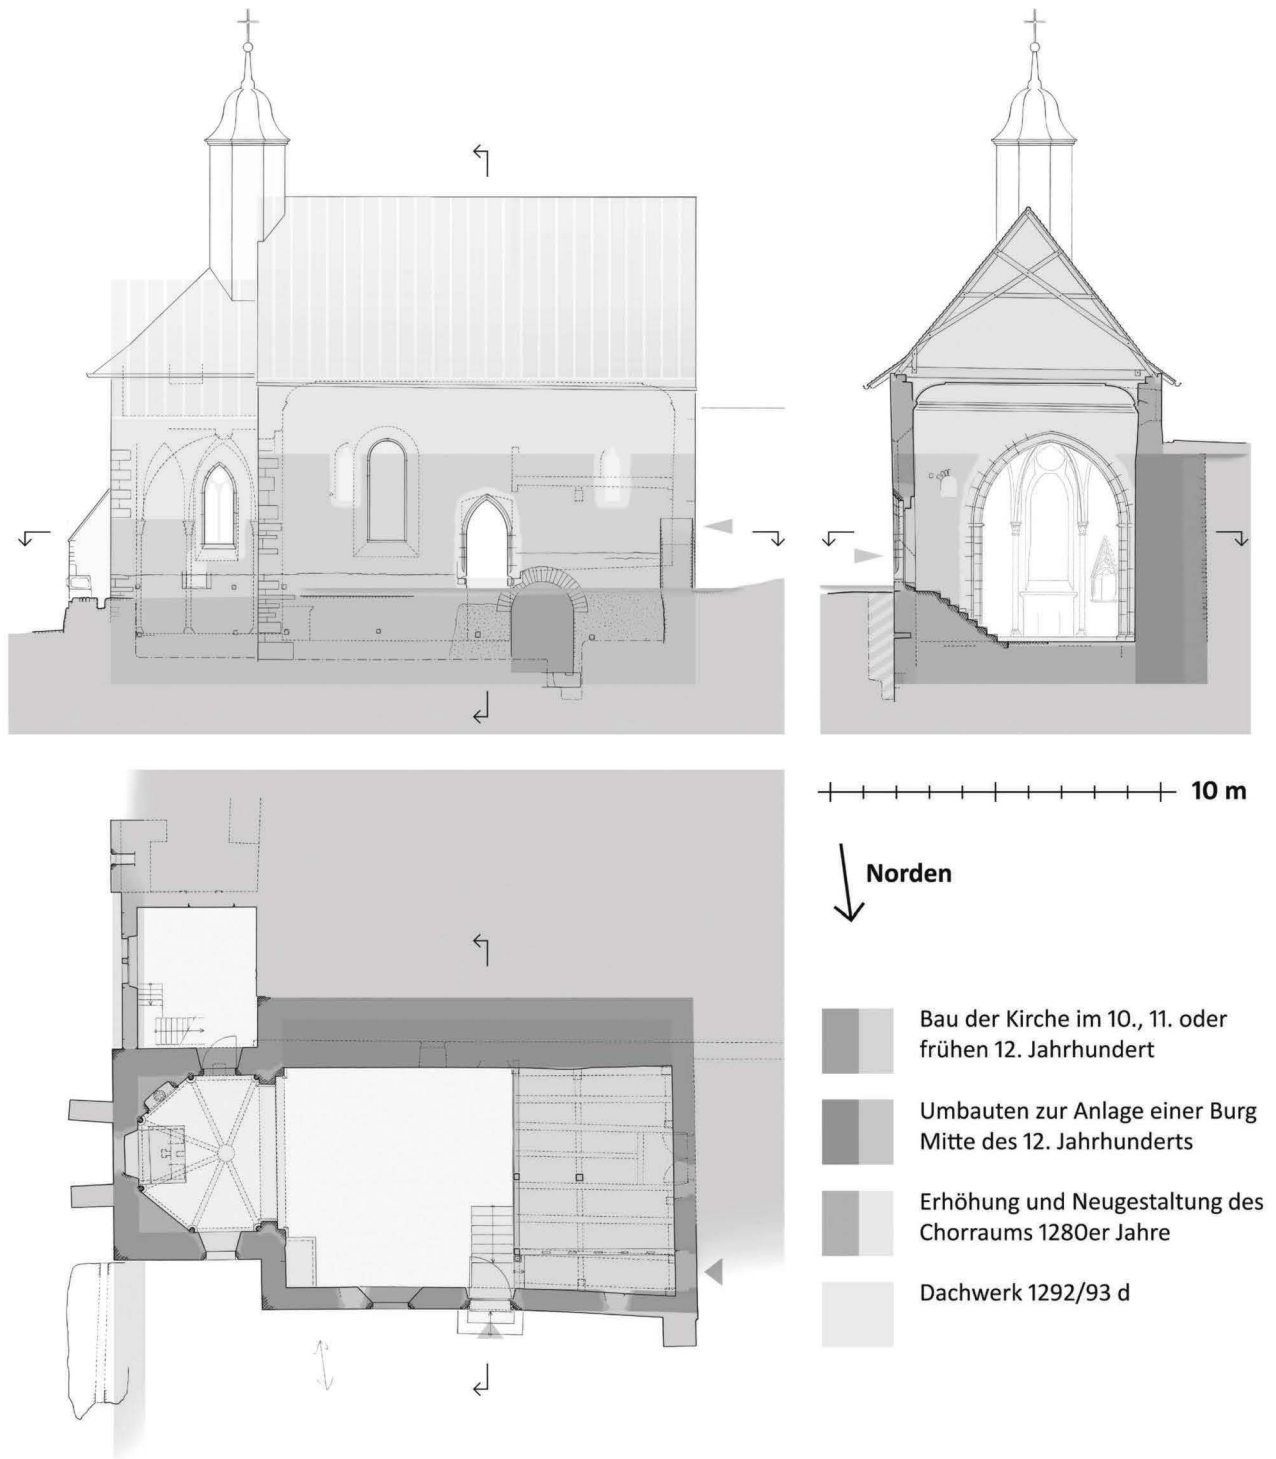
Riegel, Michaelskapelle. Umbauten des späten 13. Jahrhunderts im Aufmaß markiert. Nordansicht, Querschnitt und Grundriss auf Emporenebene (Zeichnung: King).
